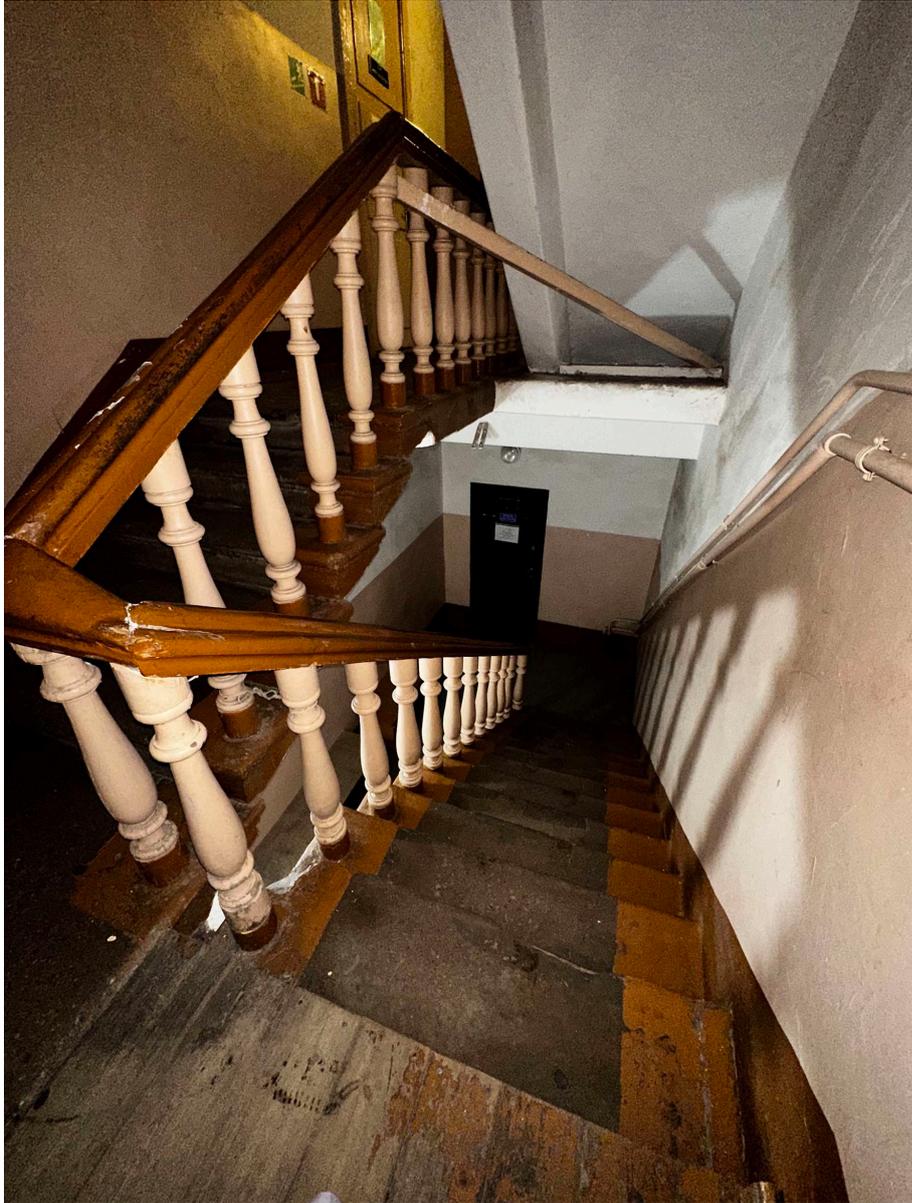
2-ой этаж. Лестничная клетка в дворовом ризалите.
